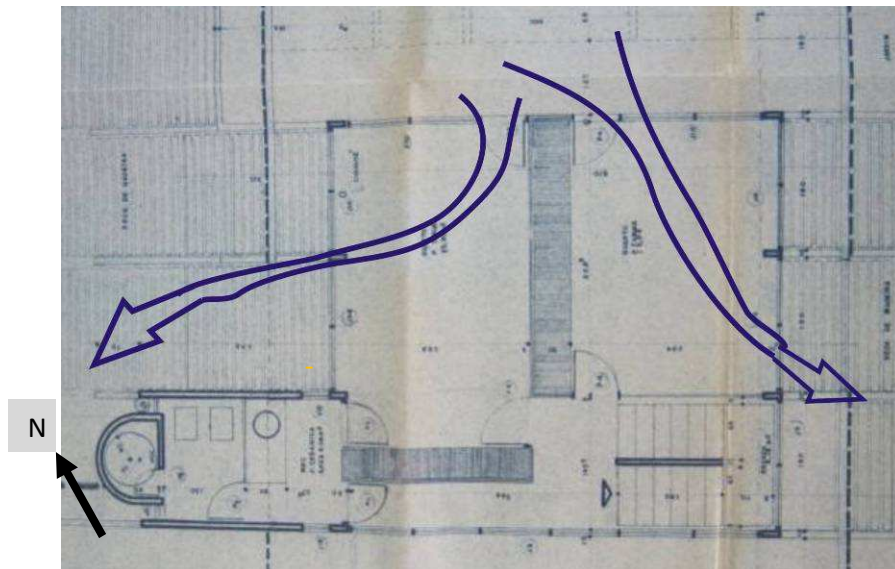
Planta do segundo pavimento: circulação interna de ar.
